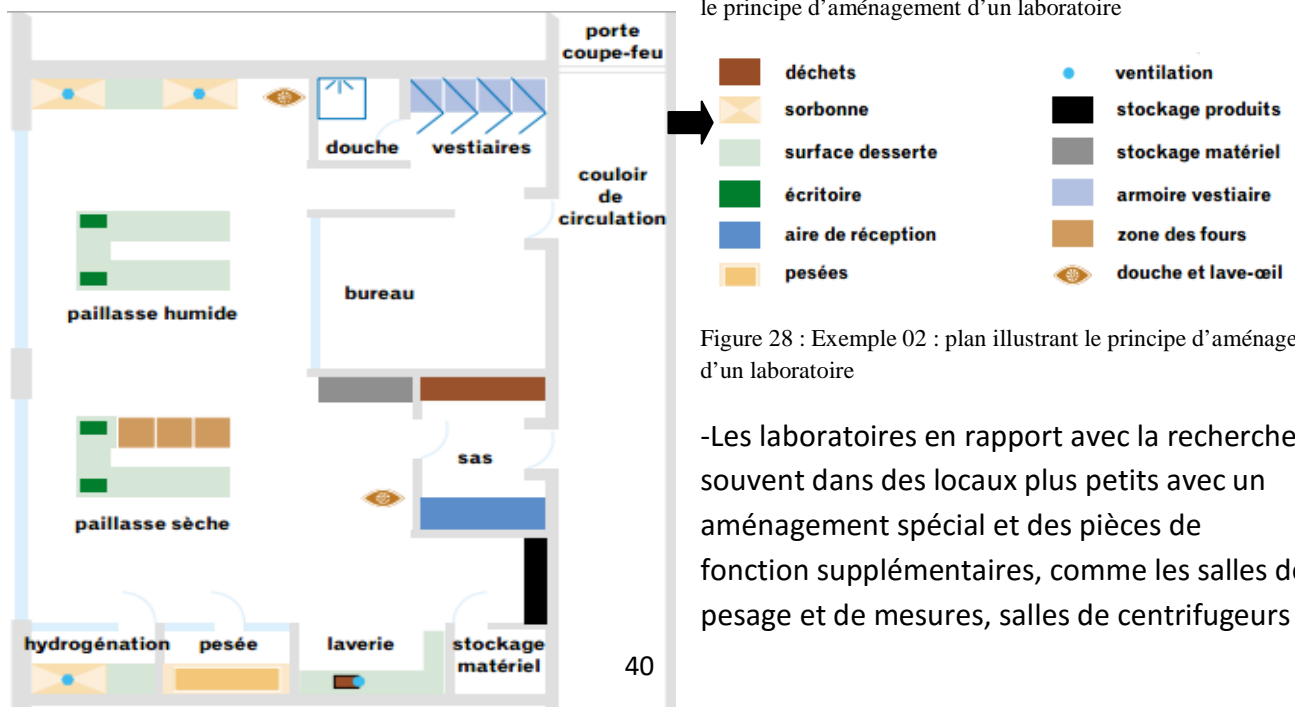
Exemple 02 : plan illustrant le principe d'aménagement d'un laboratoire
